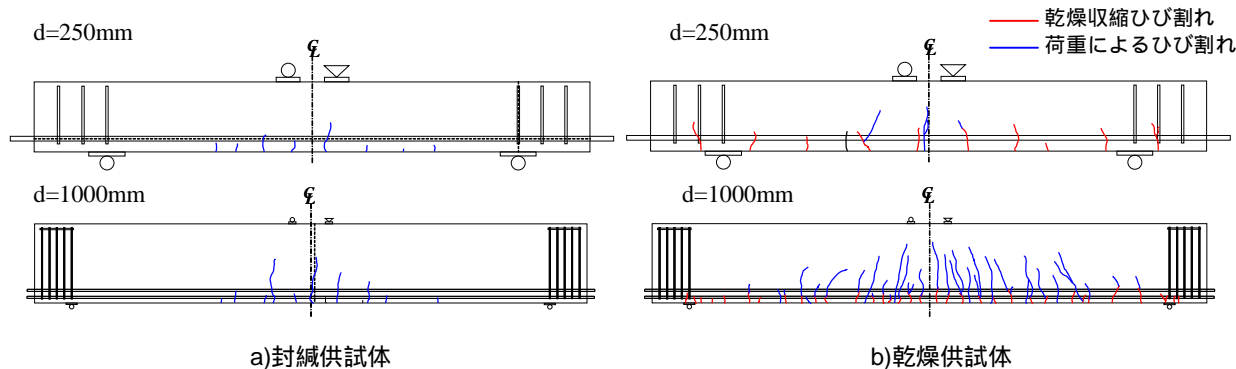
ひび割れ発生状況 (せん断応力 0.4N/mm^2 時点)
